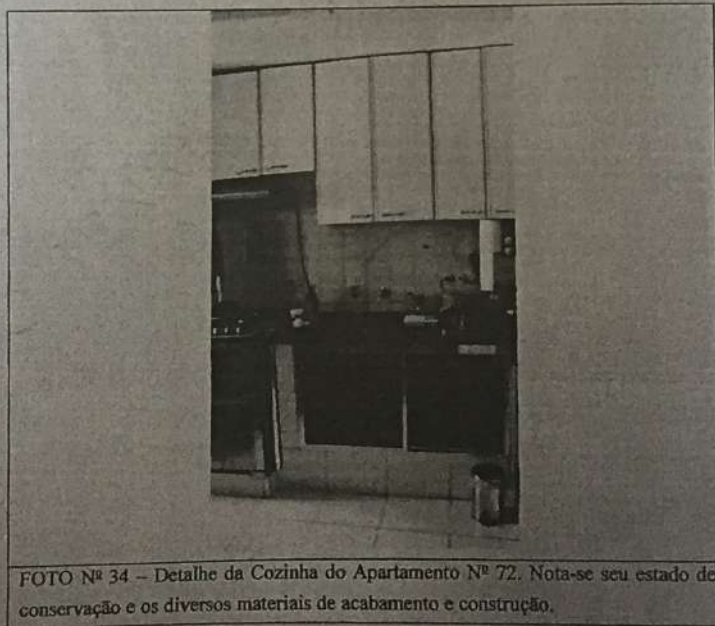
Detalhe da Cozinha do Apartamento Nº 72. Nota-se seu estado de conservação e os diversos materiais de acabamento e construção.
